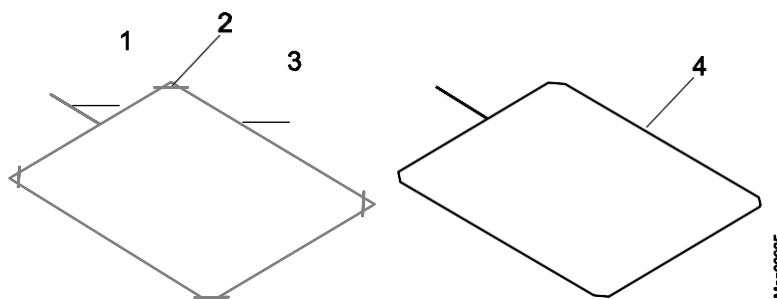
Colocar o laço indutivo em betume, asfalto ou concreto
